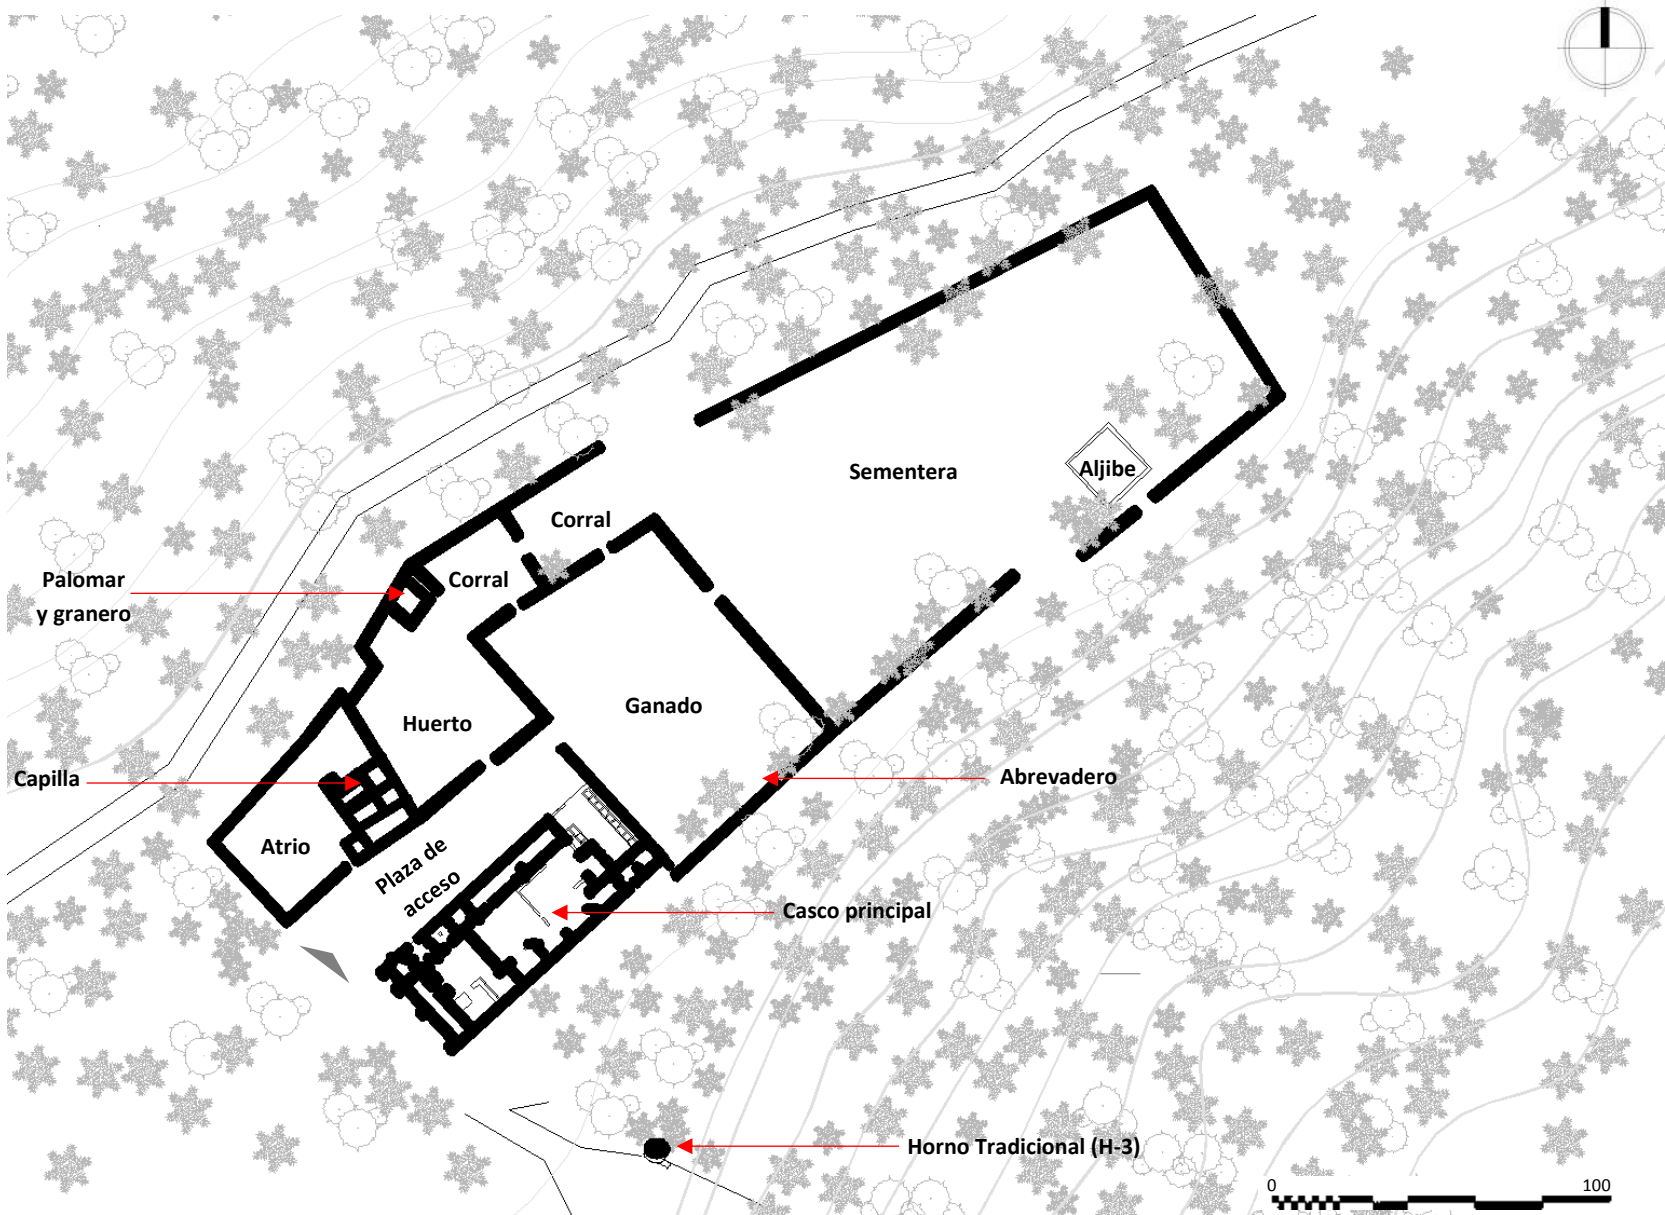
Plano de conjunto de la Hacienda Calera de Apaxco. 2017. Ver anexo de planos EA_001.
